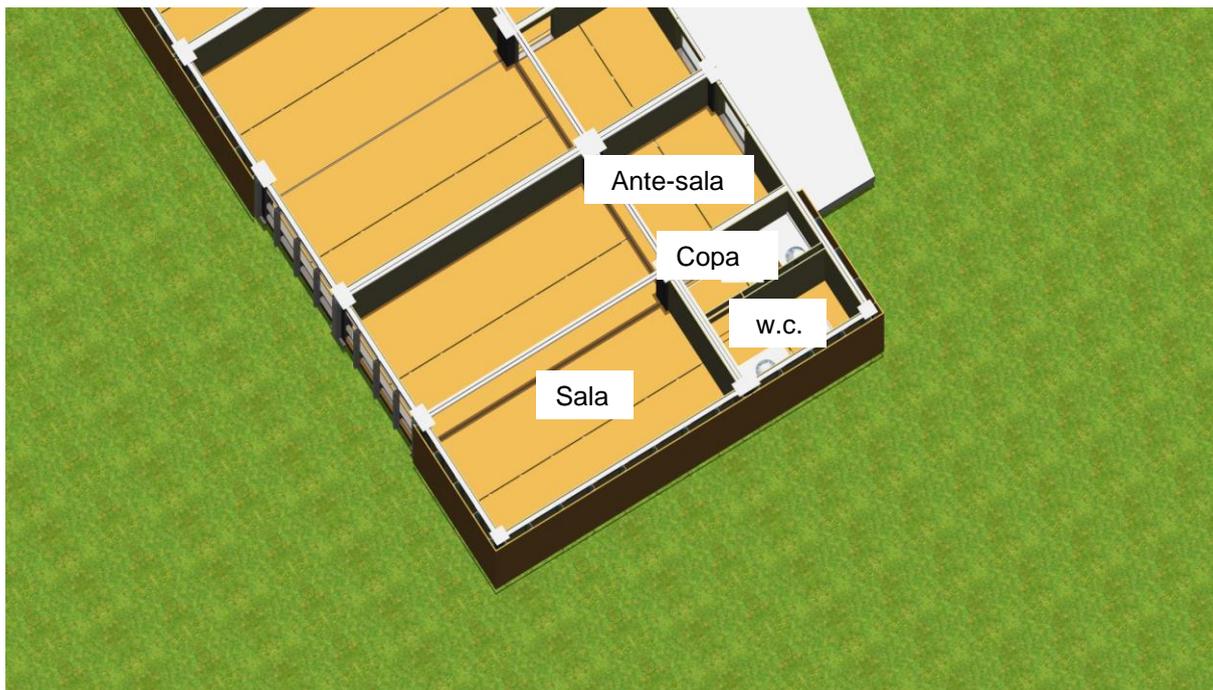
Planta baixa da sala tipo composta por três módulos.
